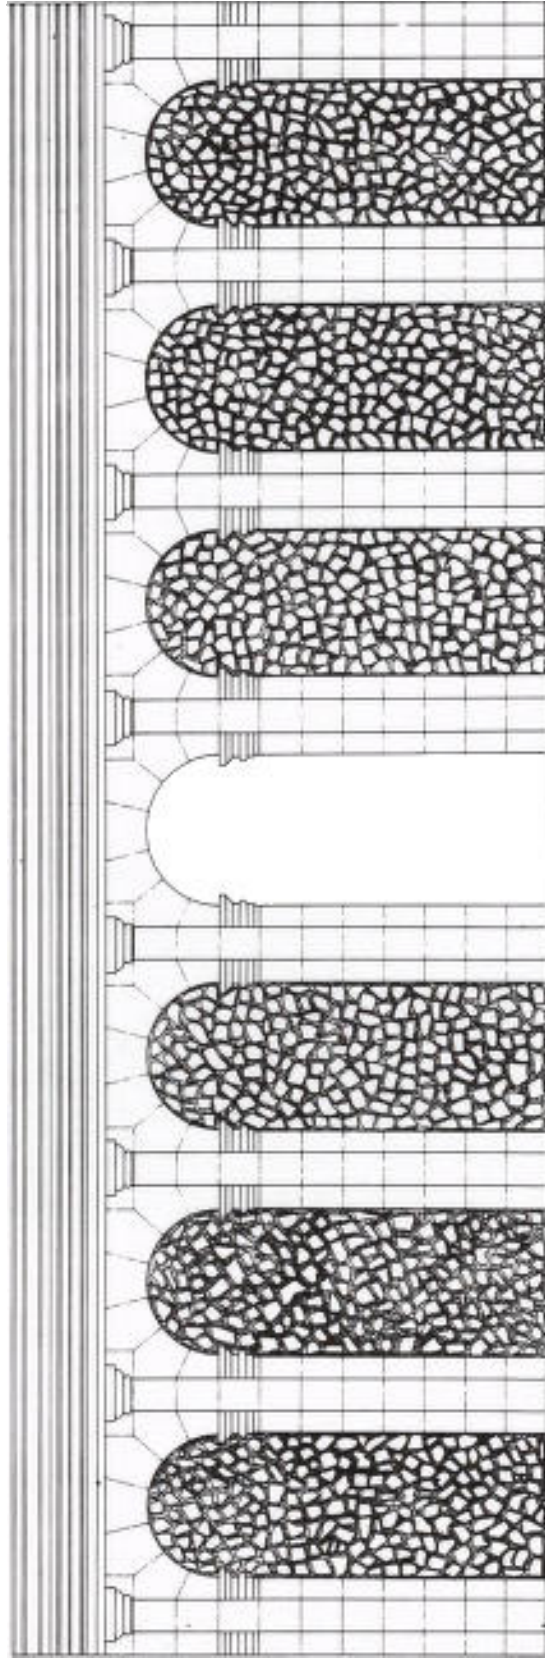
La Puerta de Santiago (reconstrucción ideal).
